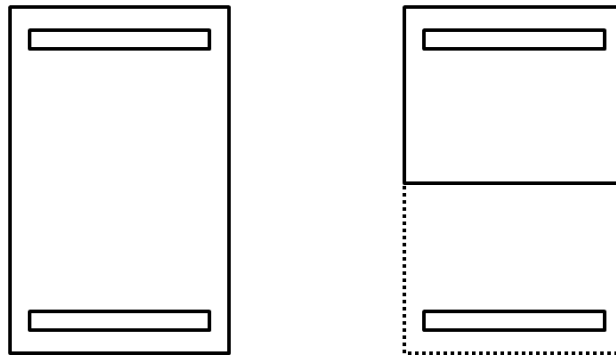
Models de secció de biga sense fissurar (esquerra) i completament fissurada (dreta)
